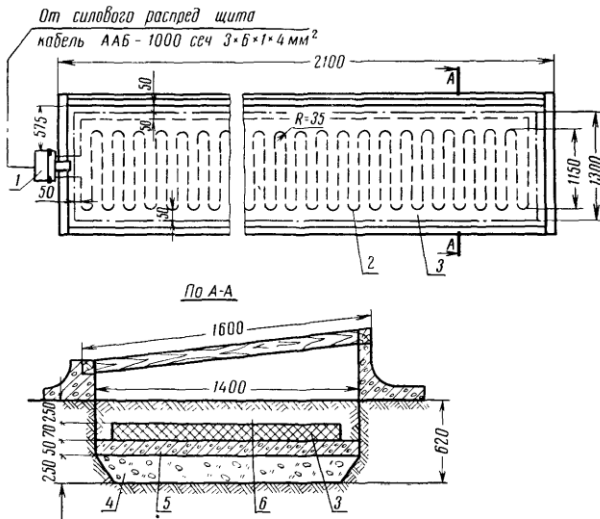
Устройство парника со сплошным асфальтобетонным покрытием нагревательного элемента:
